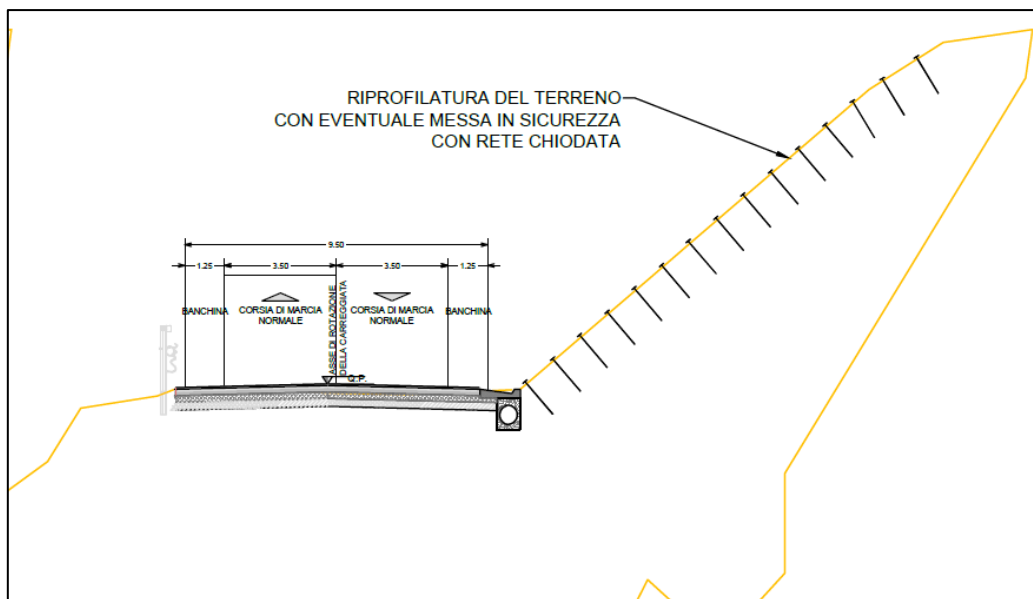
Sezione tipo 4 – Allargamento carreggiata lato monte con riprofilatura terreno
